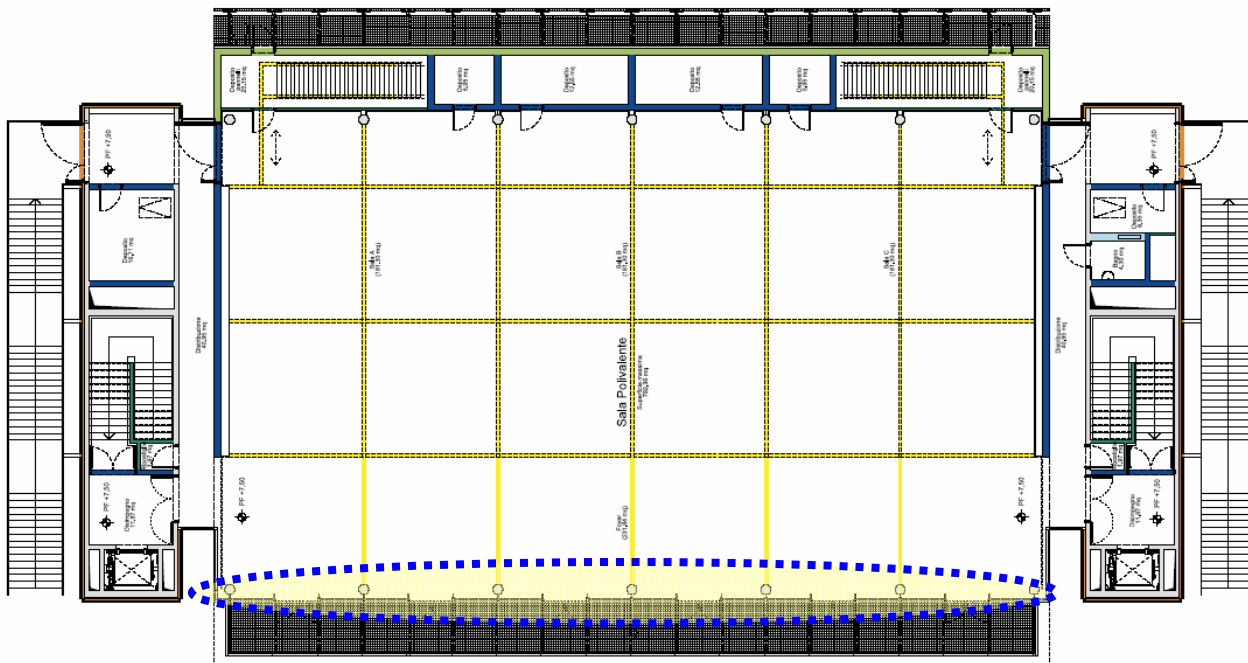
Indicazione in pianta della facciata oggetto di valutazione
